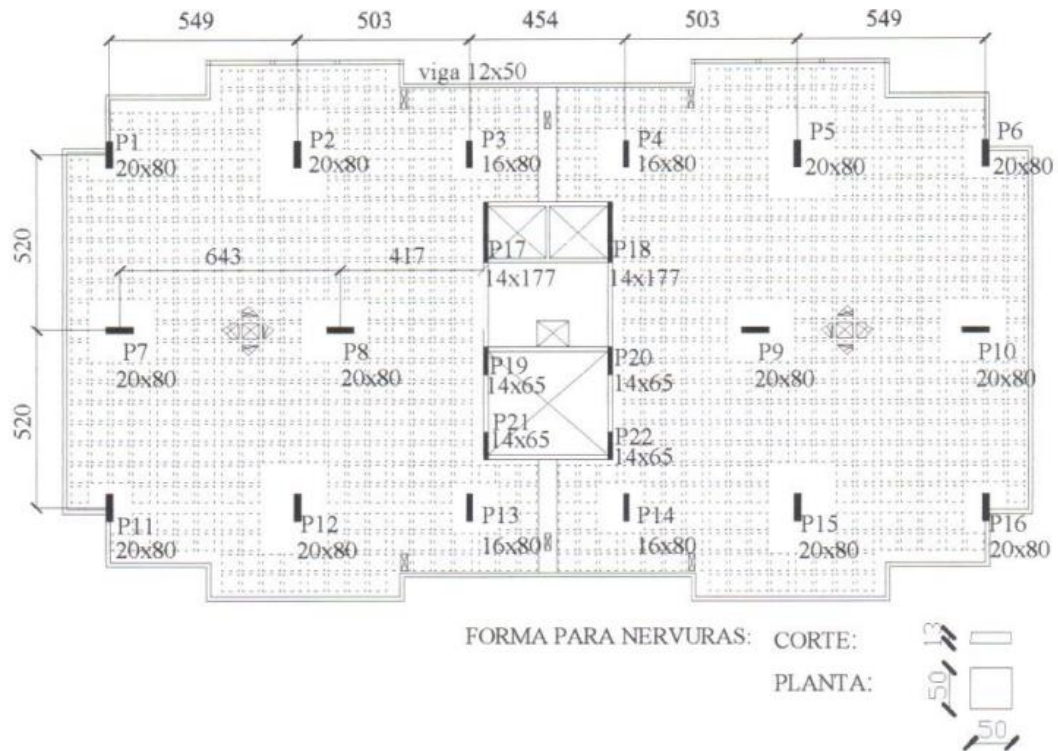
Planta baixa do terceiro exemplo (BEZERRA, 2001) – cotas em cm
